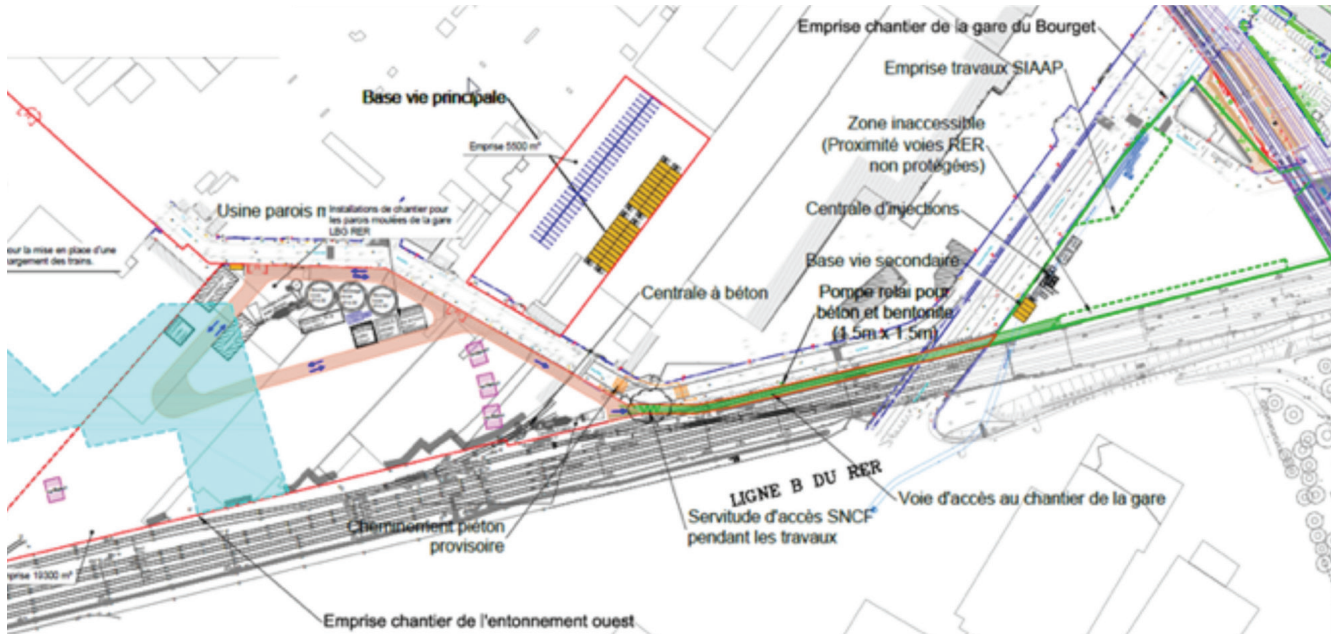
Installation de chantier emprise gare LBG, travaux SIAAP – phase 1
